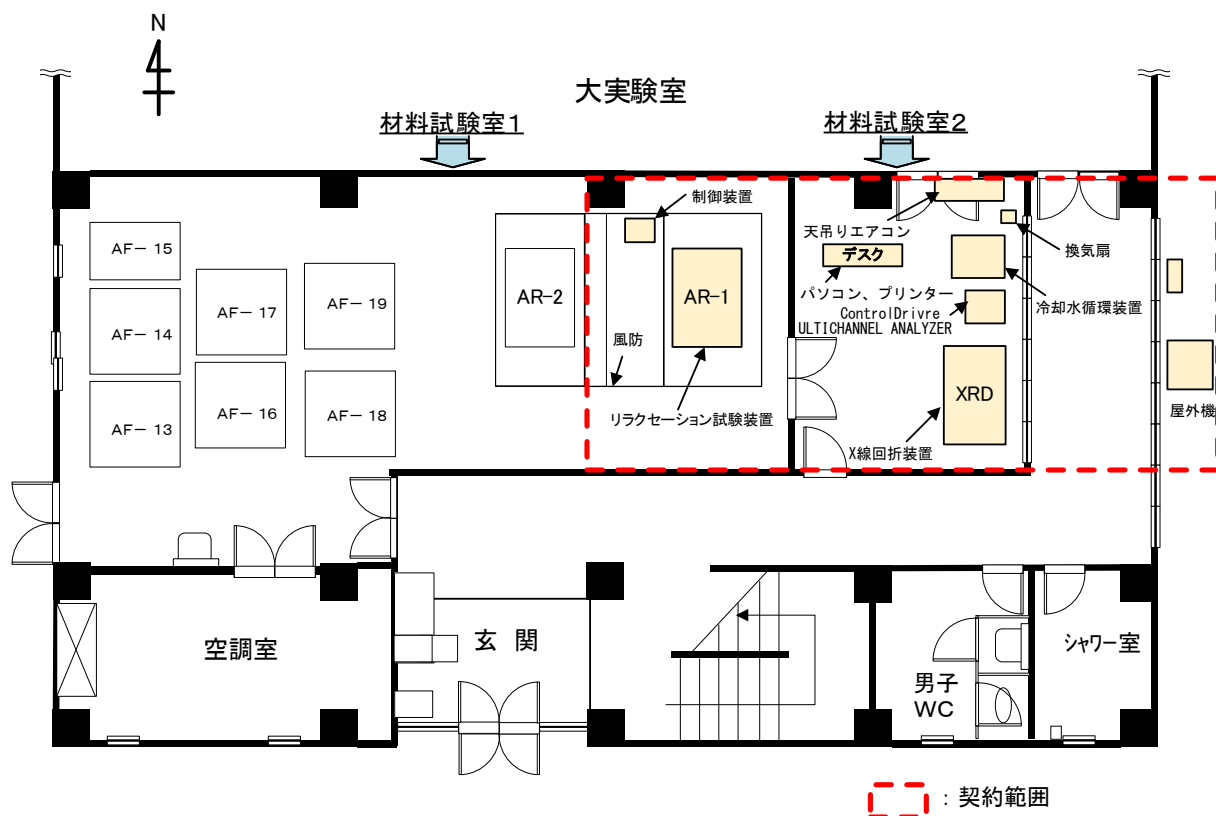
改修前のナトリウム技術開発第2試験室 1階平面図
